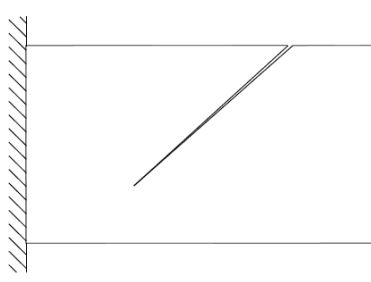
Situazione tipo di zona compressa localizzata inferiormente alla trave.
